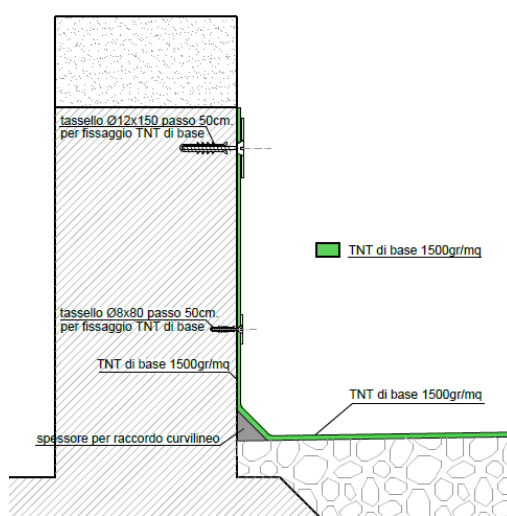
a - Posa del TNT di base (strato di colore verde) del peso di 1500 gr/mq sul parapetto/timpano
